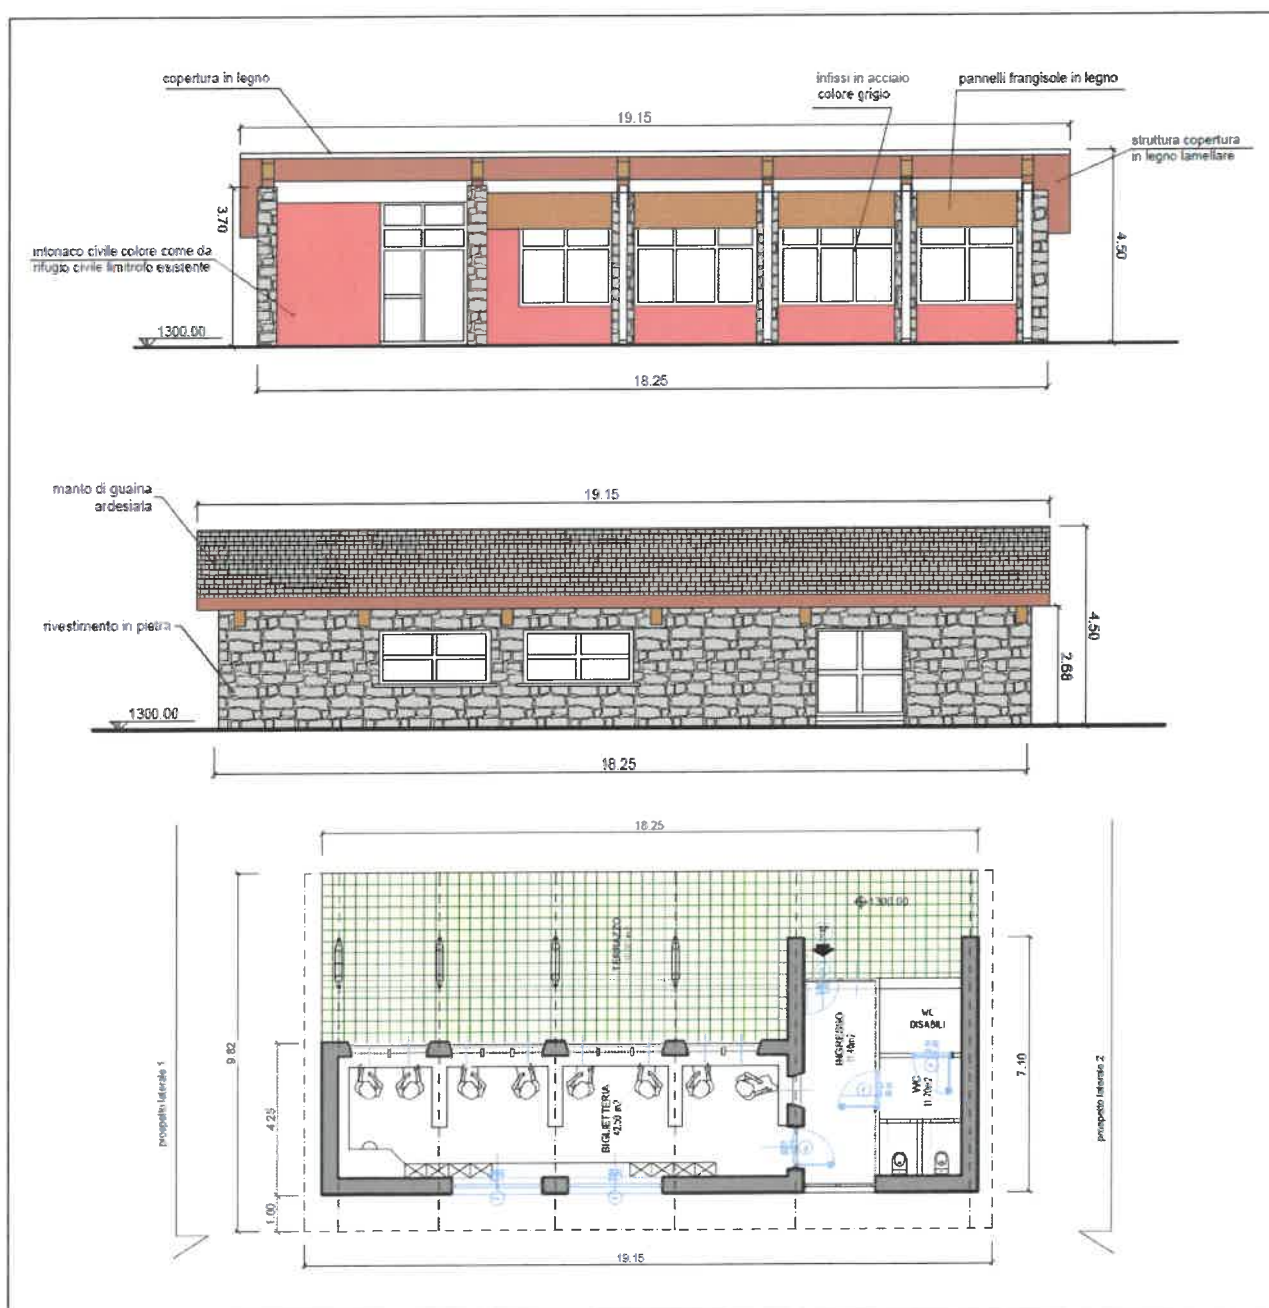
Biglietteria (valle) prospetto frontale, prospetto posteriore e pianta (Elaborato EG13)
